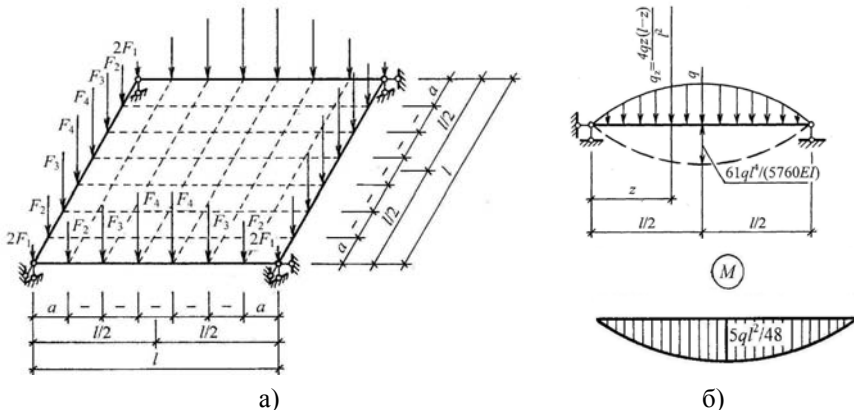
Расчетные схемы контурных элементов (ферм) перекрестной системы (а) и их балочного аналога (б)
